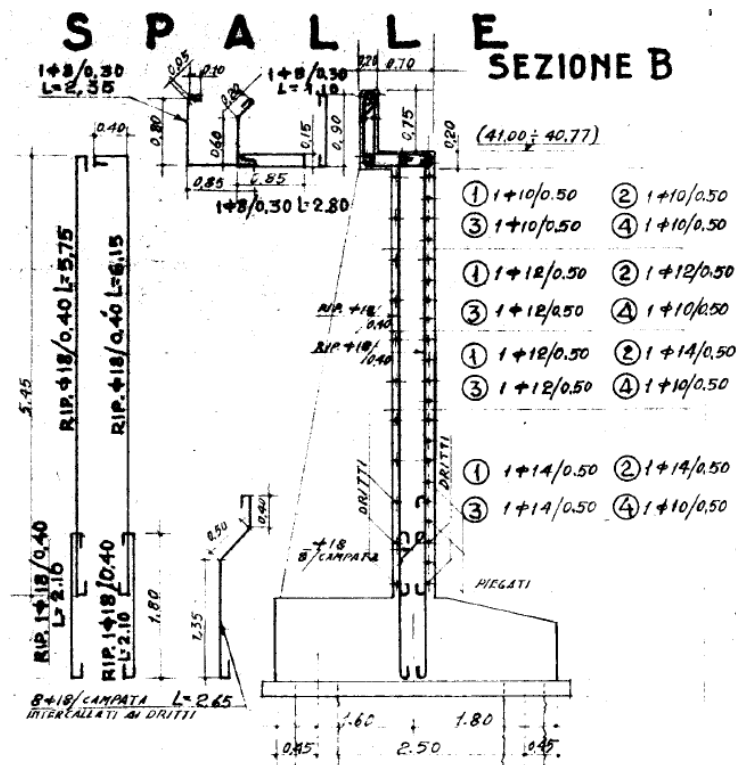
Documento as-built “Sottovia via Zanardi al km 10+793,18” – Sezione trasversale con armature spalla
